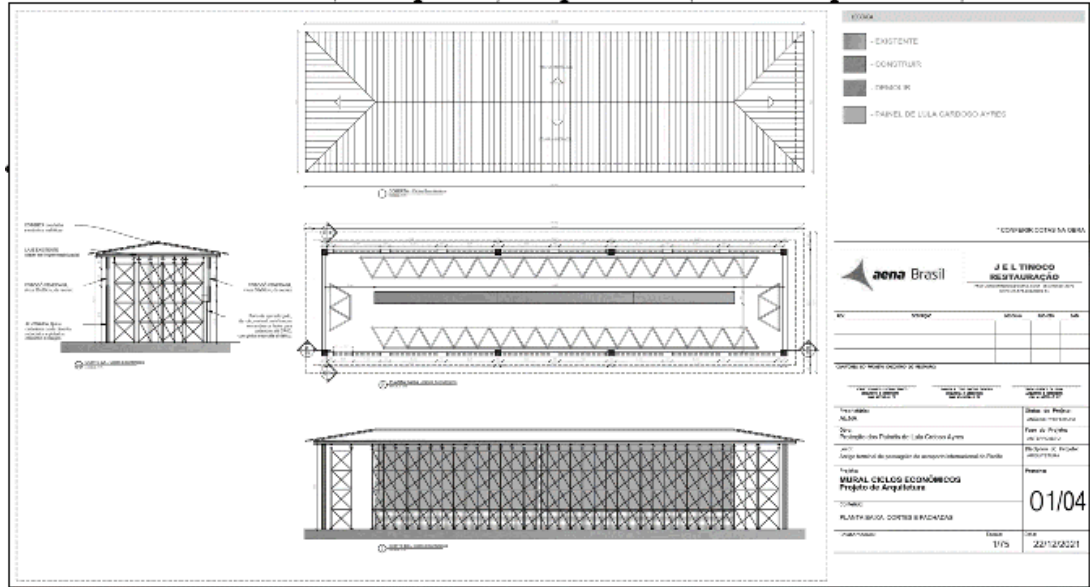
Projeto do abrigo Folclore. Semelhante projetado para o outro. FONTE: autores.
